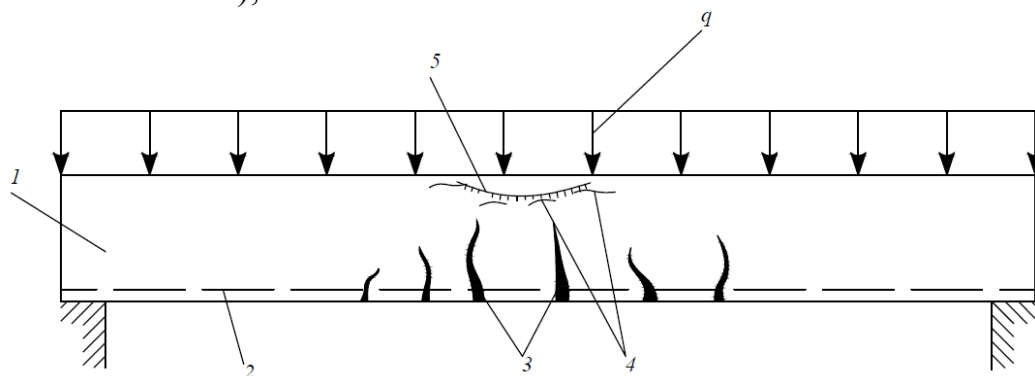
Разрушение бетона сжатой зоны в нормальном сечении: 1 – изгибаемый элемент; 2 – рабочая арматура растянутой зоны; 3 – нормальные трещины в растянутой зоне; 4 – трещины в сжатой зоне в нормальном сечении (разрушение бетона); 5 – отслоение бетона в сжатой зоне сечения.
